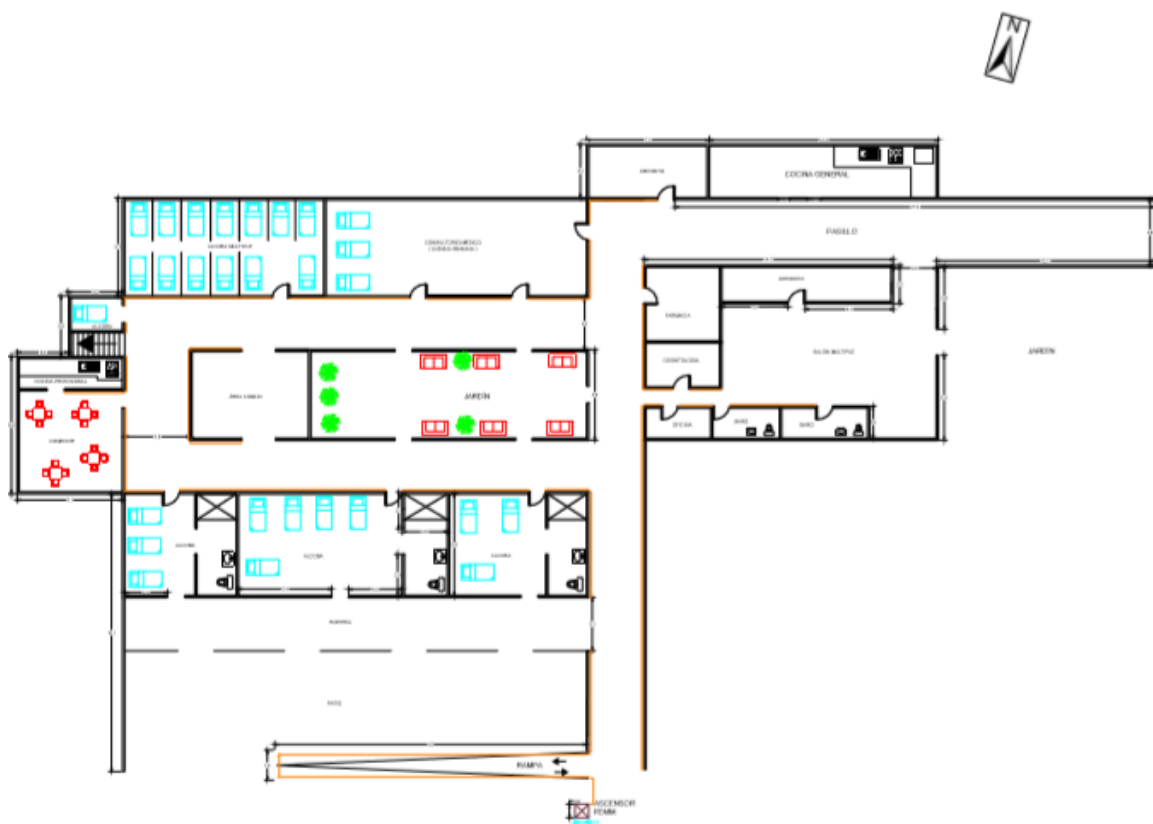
Plano con las modificaciones planteadas en el pabellón María Marcelina
